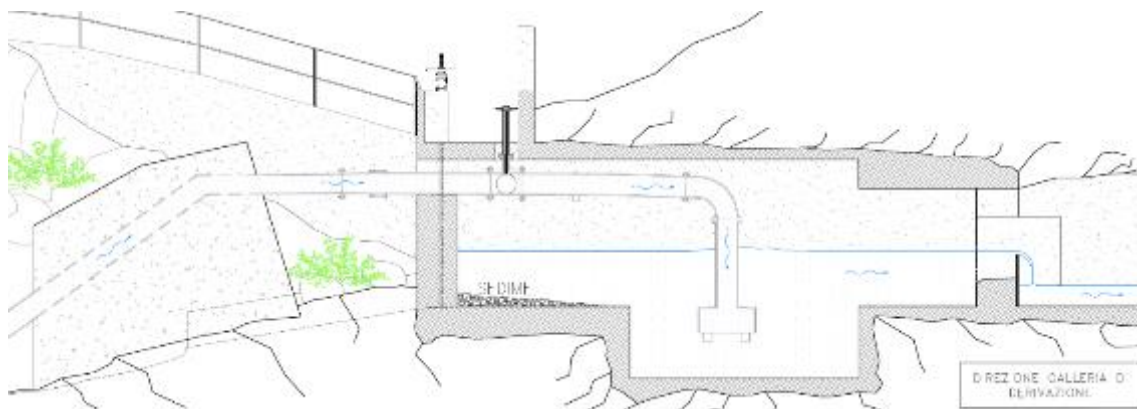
sezione longitudinale del manufatto di scarico (stato di consistenza marzo 2021)
